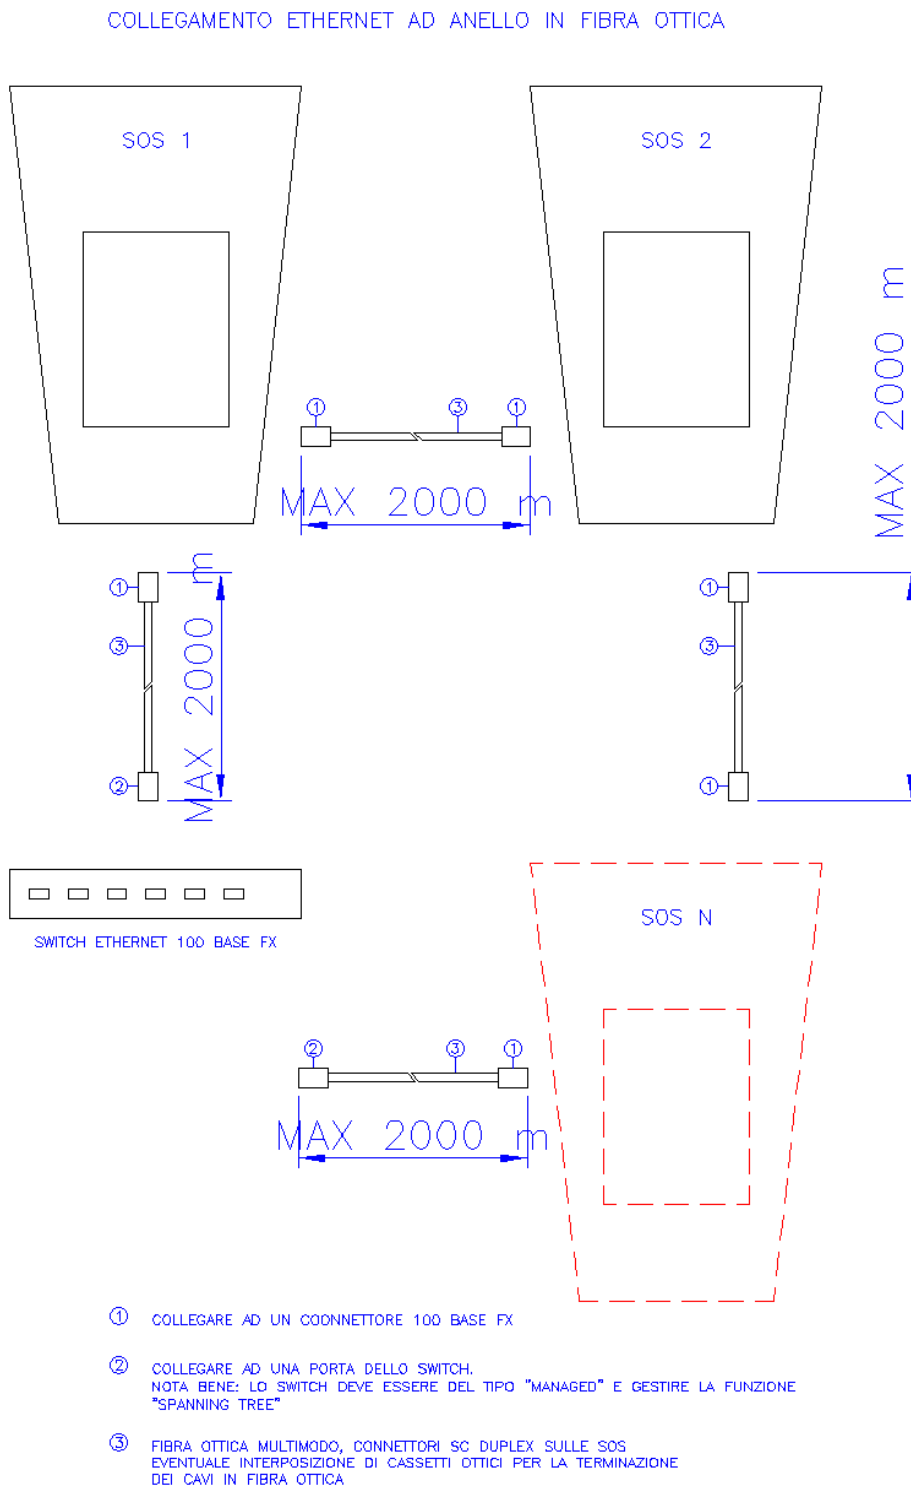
Collegamento ad anello a fibra ottica multimodale
